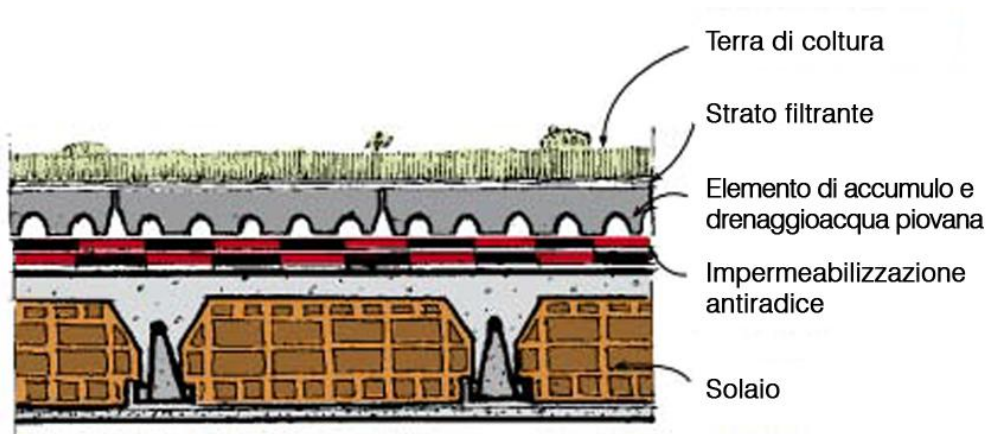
Illustrazione schematica dell'applicazione di un tetto verde di tipo estensivo
